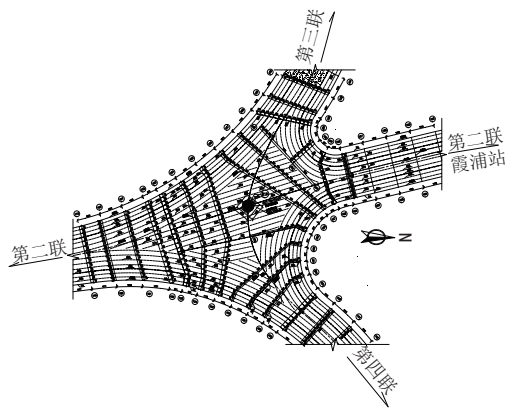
合 1#墩(三联交汇)位置处钢箱梁底板平面图
